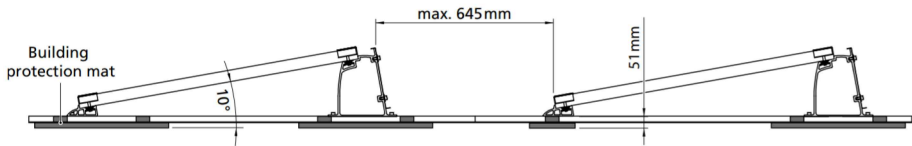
DETAIL KONSTRUKCE PRO ULOŽENÍ FV PANELŮ
